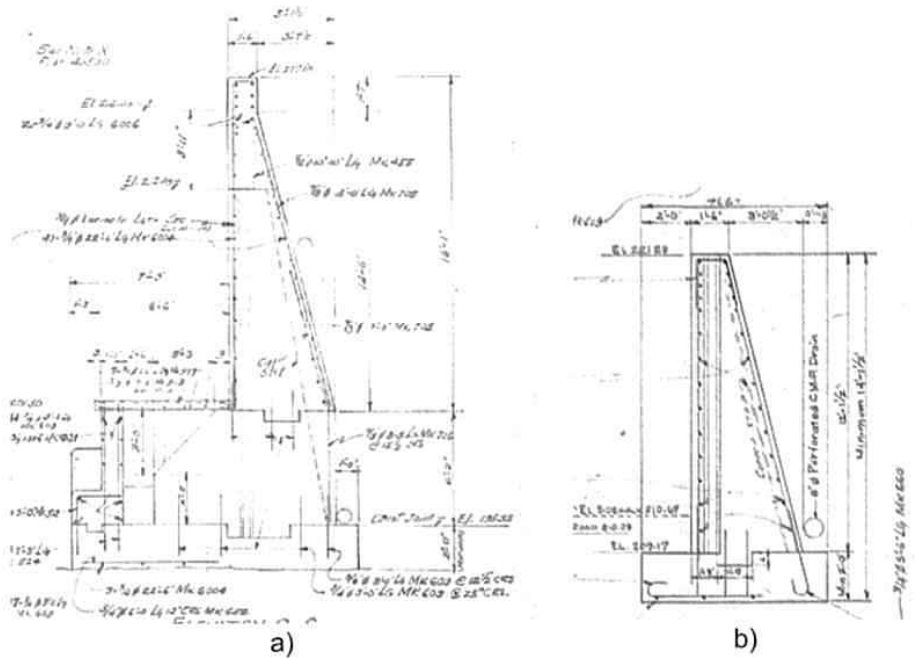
Coupes types des murs de soutènement (extrait des plans 5170-1951)
